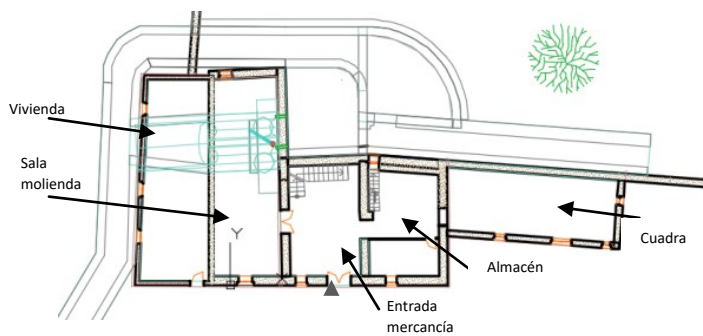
Planta año 1940. 2016. Fuentes propias
